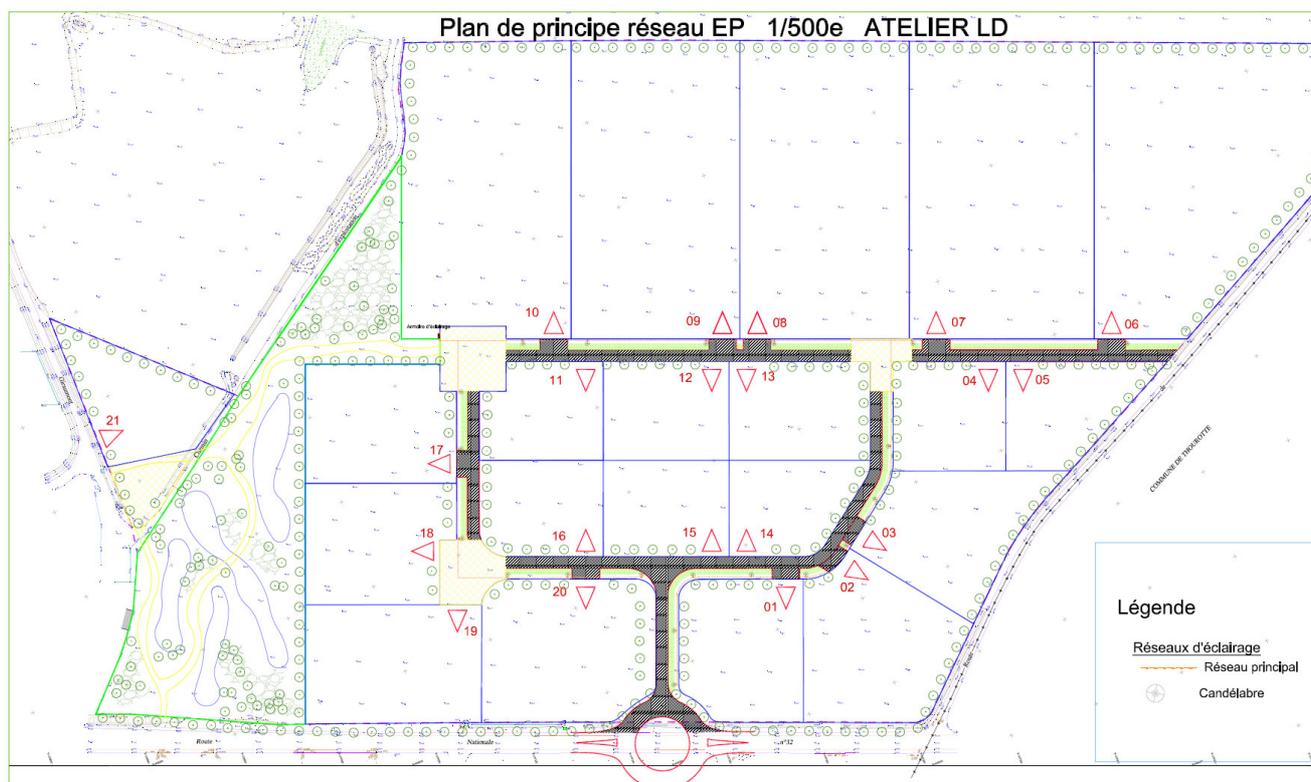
Plan de principe du réseau électrique de la future Z.A.C. (source : Atelier LD)
